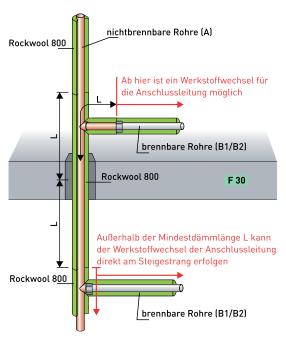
Anschlussleitungen an Steigleitungen mit Durchführungsdämmungen R 30, bei Angabe einer Mindestdämmlänge L beidseitig der Durchführung
